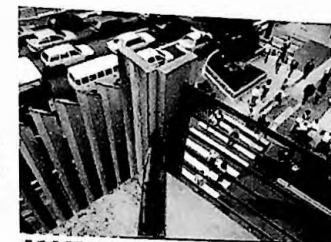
Brise vertical sobre a calçada da Avenida Paulista
